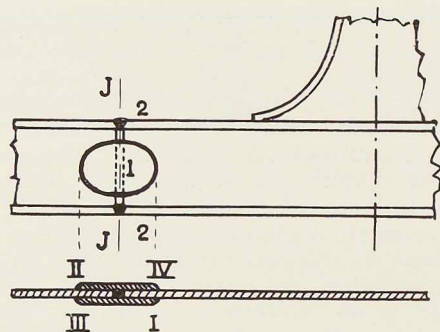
Renforcement d'un joint de montage par couvre-joints soudés.
